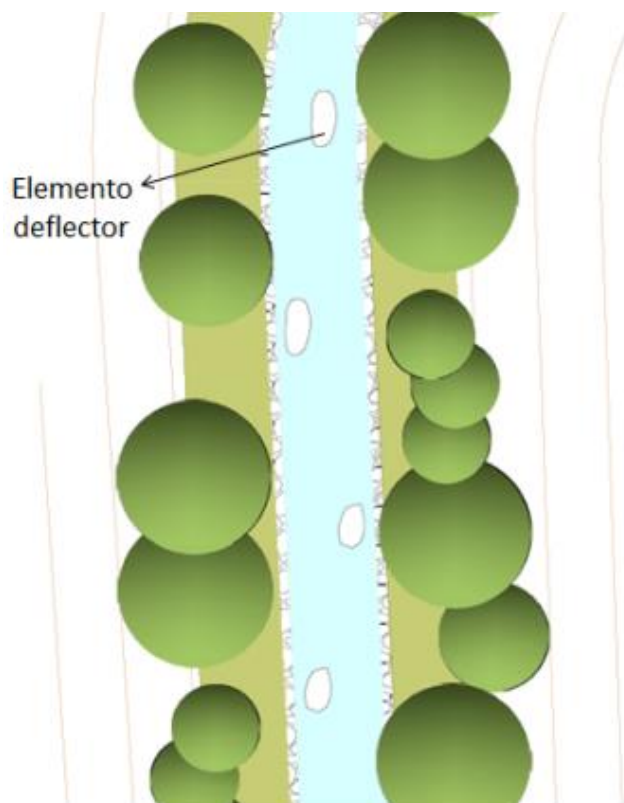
Planta de um troço retilíneo do canal 1 com colocação de elementos defletores alternados.
